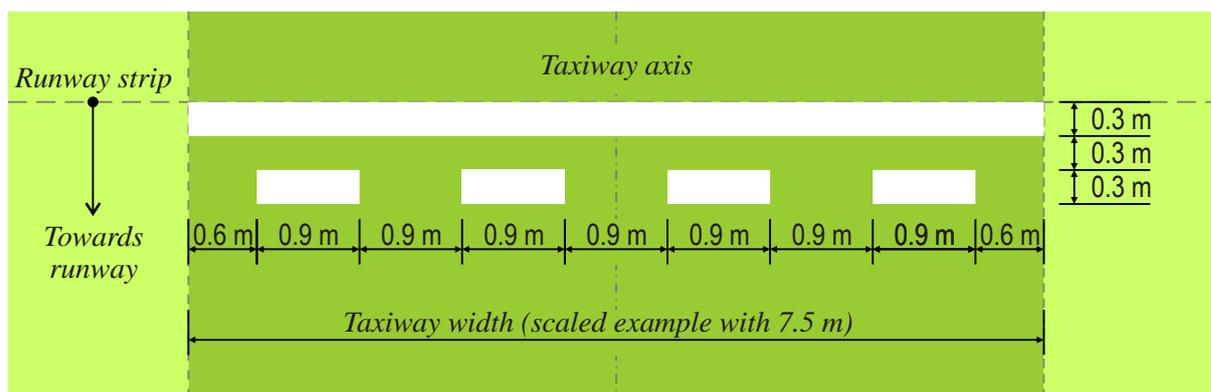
Marking per la posizione di attesa di pista su vie di circolazione non pavimentate
